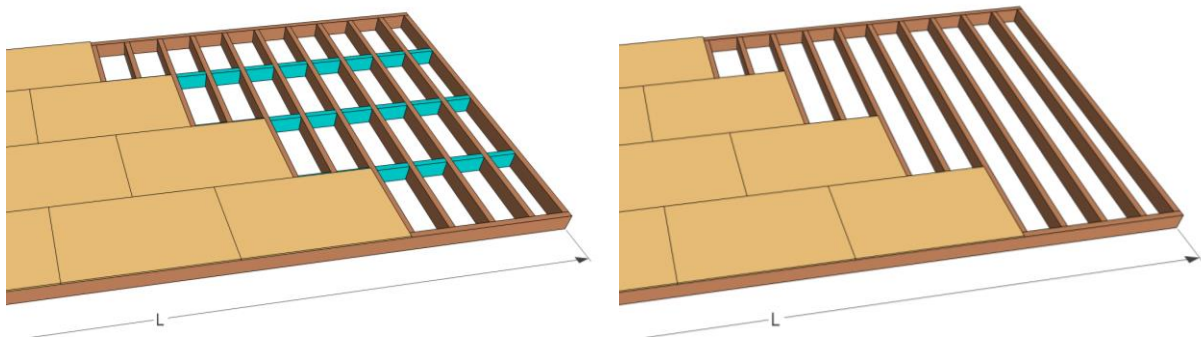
Diaphragme bloqué (gauche) ou non bloqué (droite)
